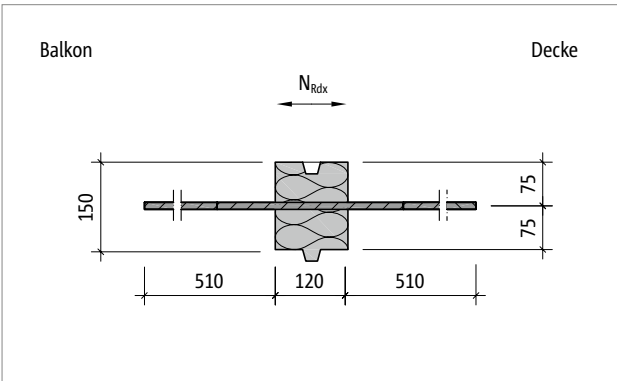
Schöck Isokorb® XT Typ H-NN2: Produktgrundriss
